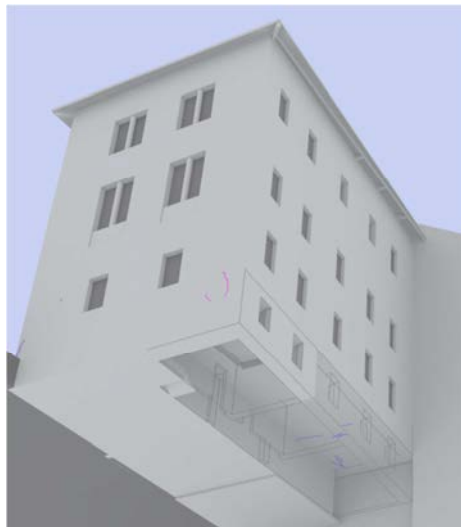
Individuazione nel modello tridimensionale di alcune fessure al piano seminterrato.
